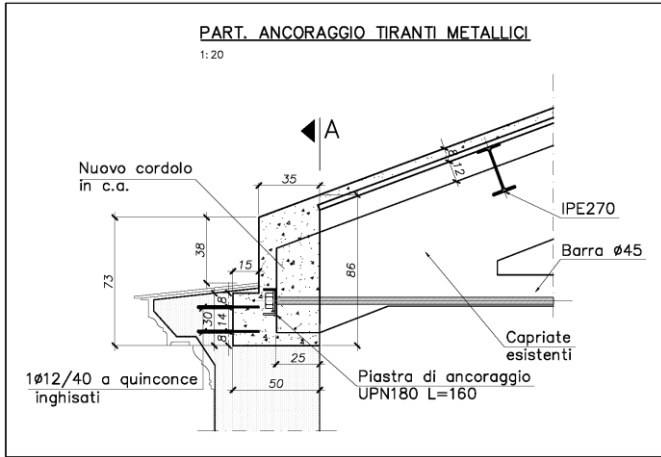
Dettaglio dell'ancoraggio nuovo tirante metallico/ Detail of the anchoring of the tie frame
